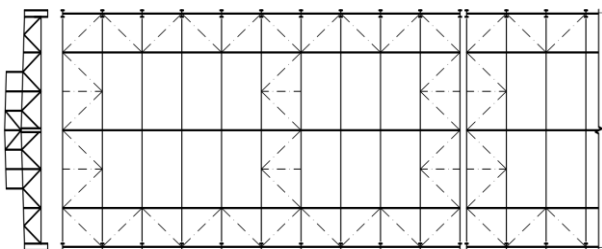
Горизонтальные продольные связи по нижним поясам ферм
